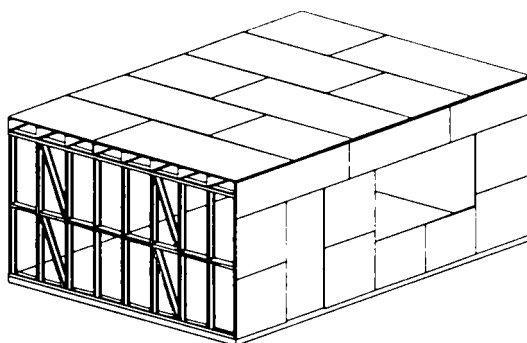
ELEMENT PREFABRICAT ÎN CAZUL METODEI MODULARE
